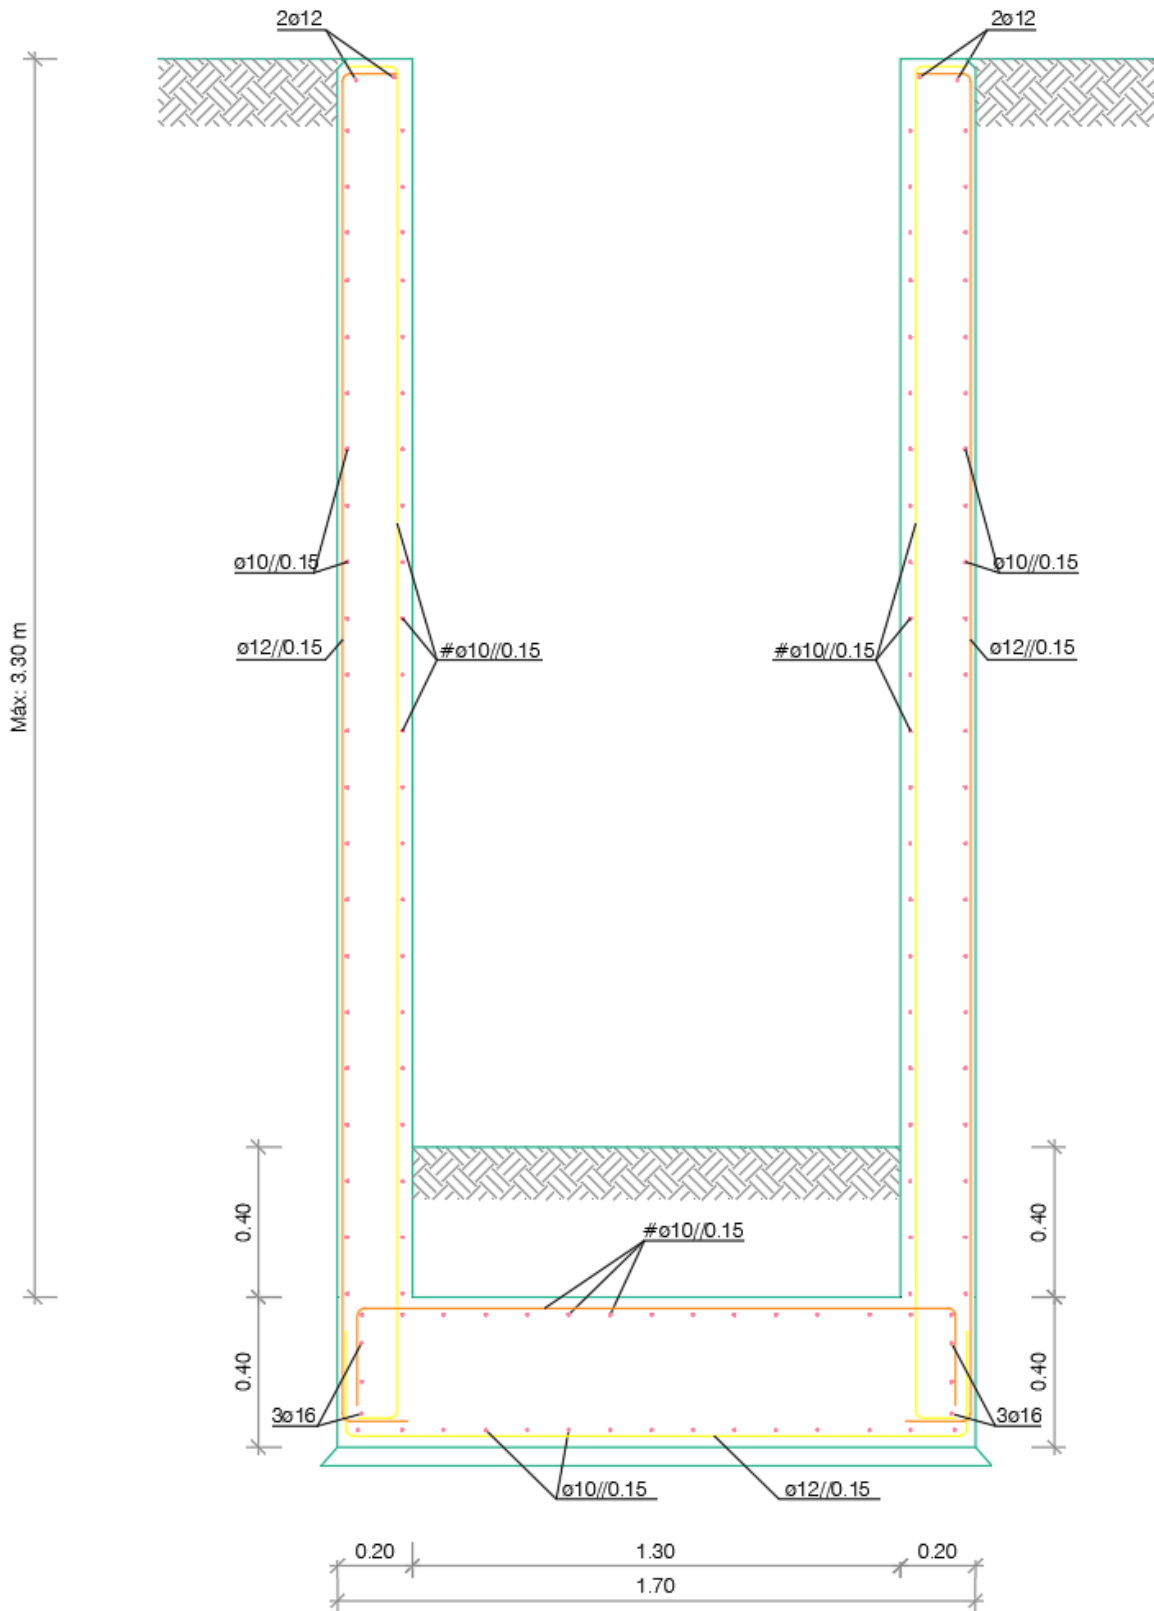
Pormenor Muro Suporte 1 (Projeto de estruturas).
